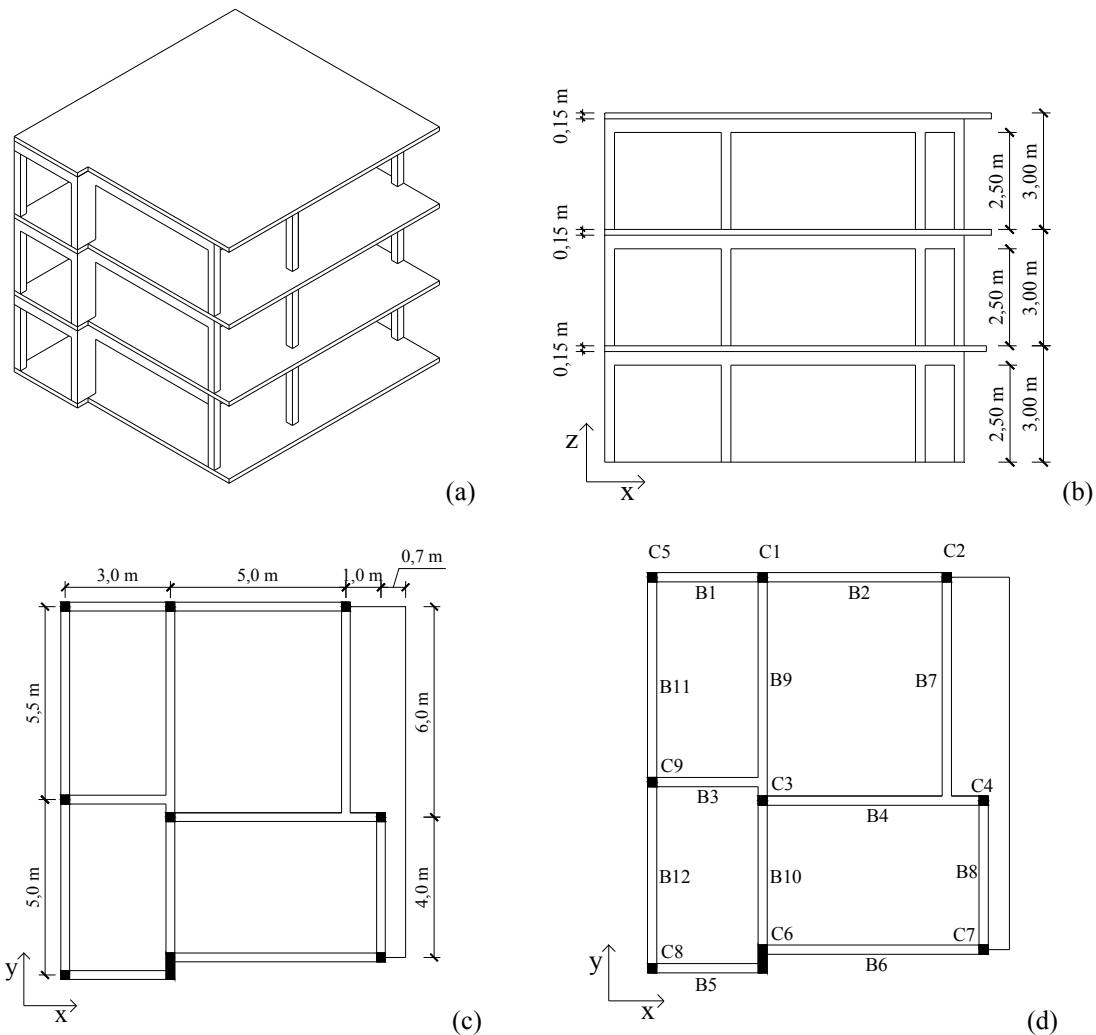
Apresentação do edifício: (a) vista 3D da estrutura de ensaio; (b) vista lateral da estrutura; (c) dimensões em planta (d) identificação dos pilares e das vigas.
